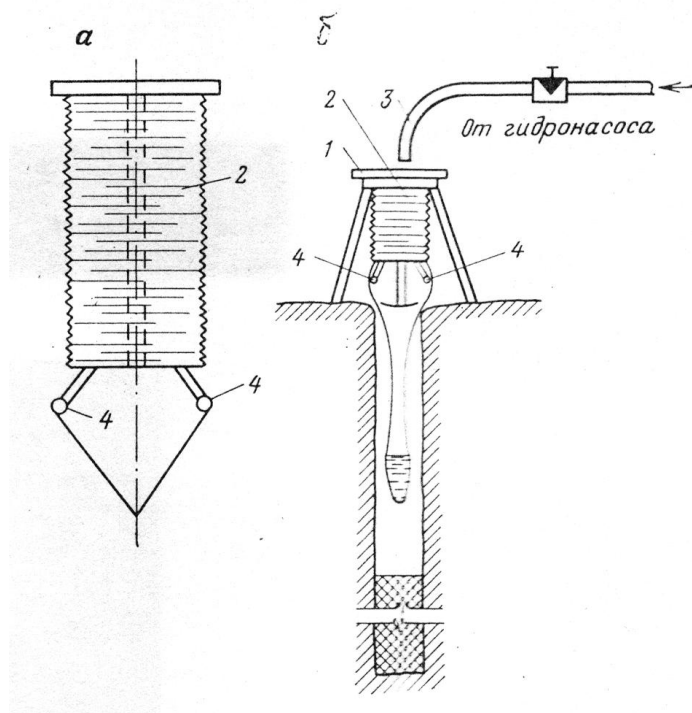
Устройство для размещения полиэтиленового рукава под гидрозабойку в скважину:
